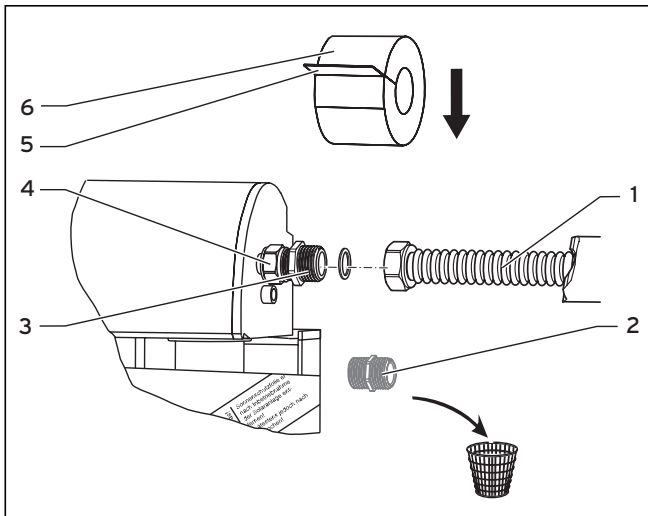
Vor- und Rücklauf mit Schlauchleitung anschließen
